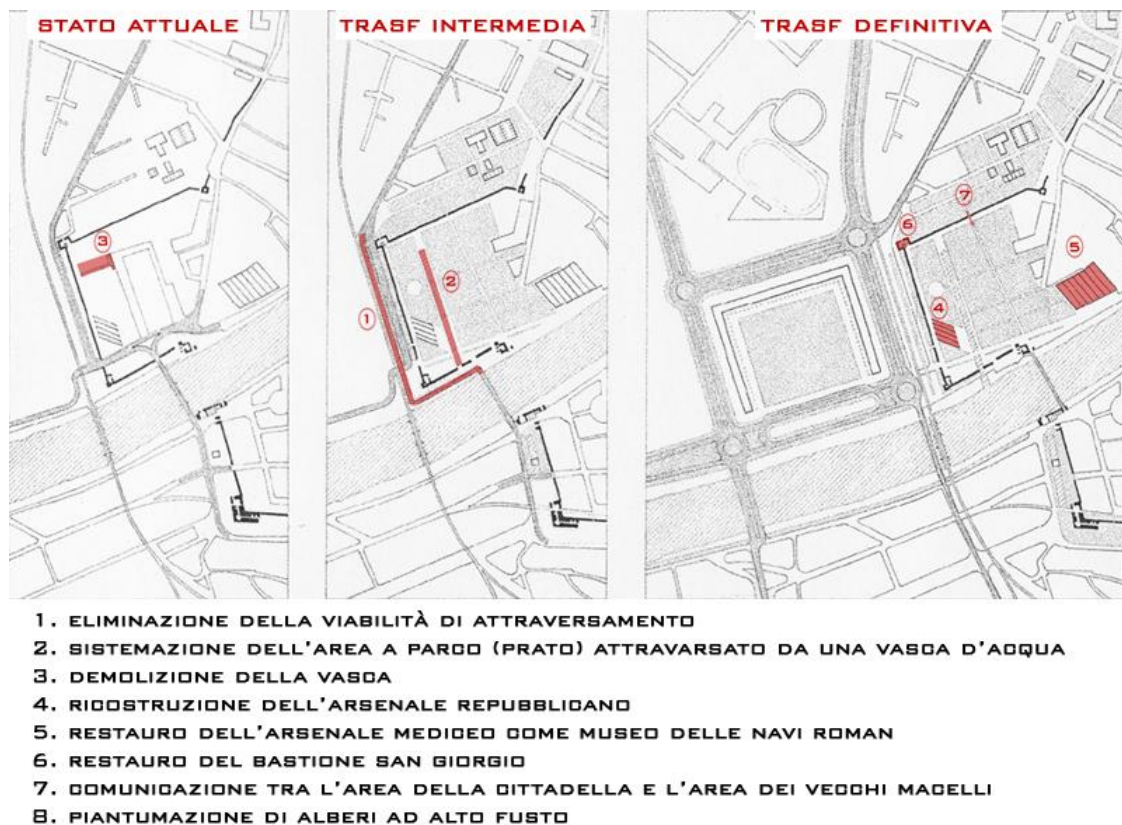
Planimetria del progetto dell'arch. Carmassi
